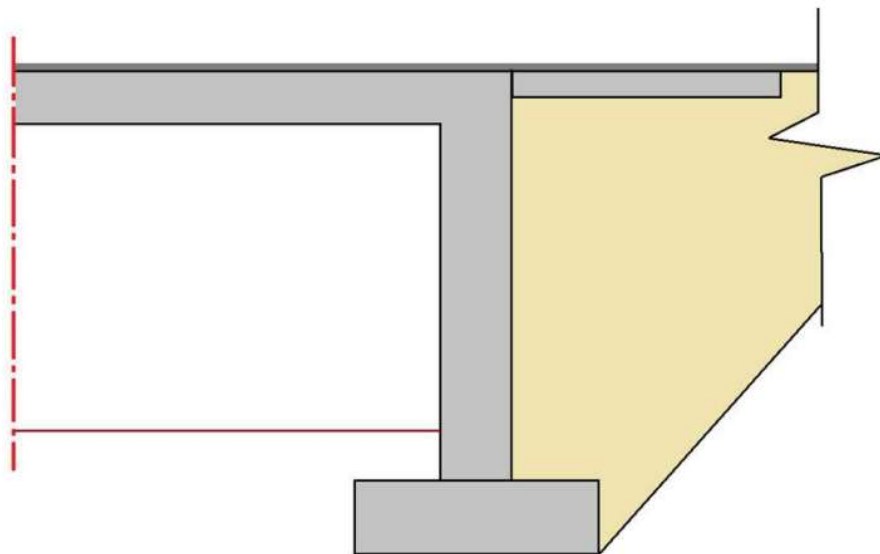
Integrovaný most s přechodovou deskou bez předpětí (zdroj [8])
